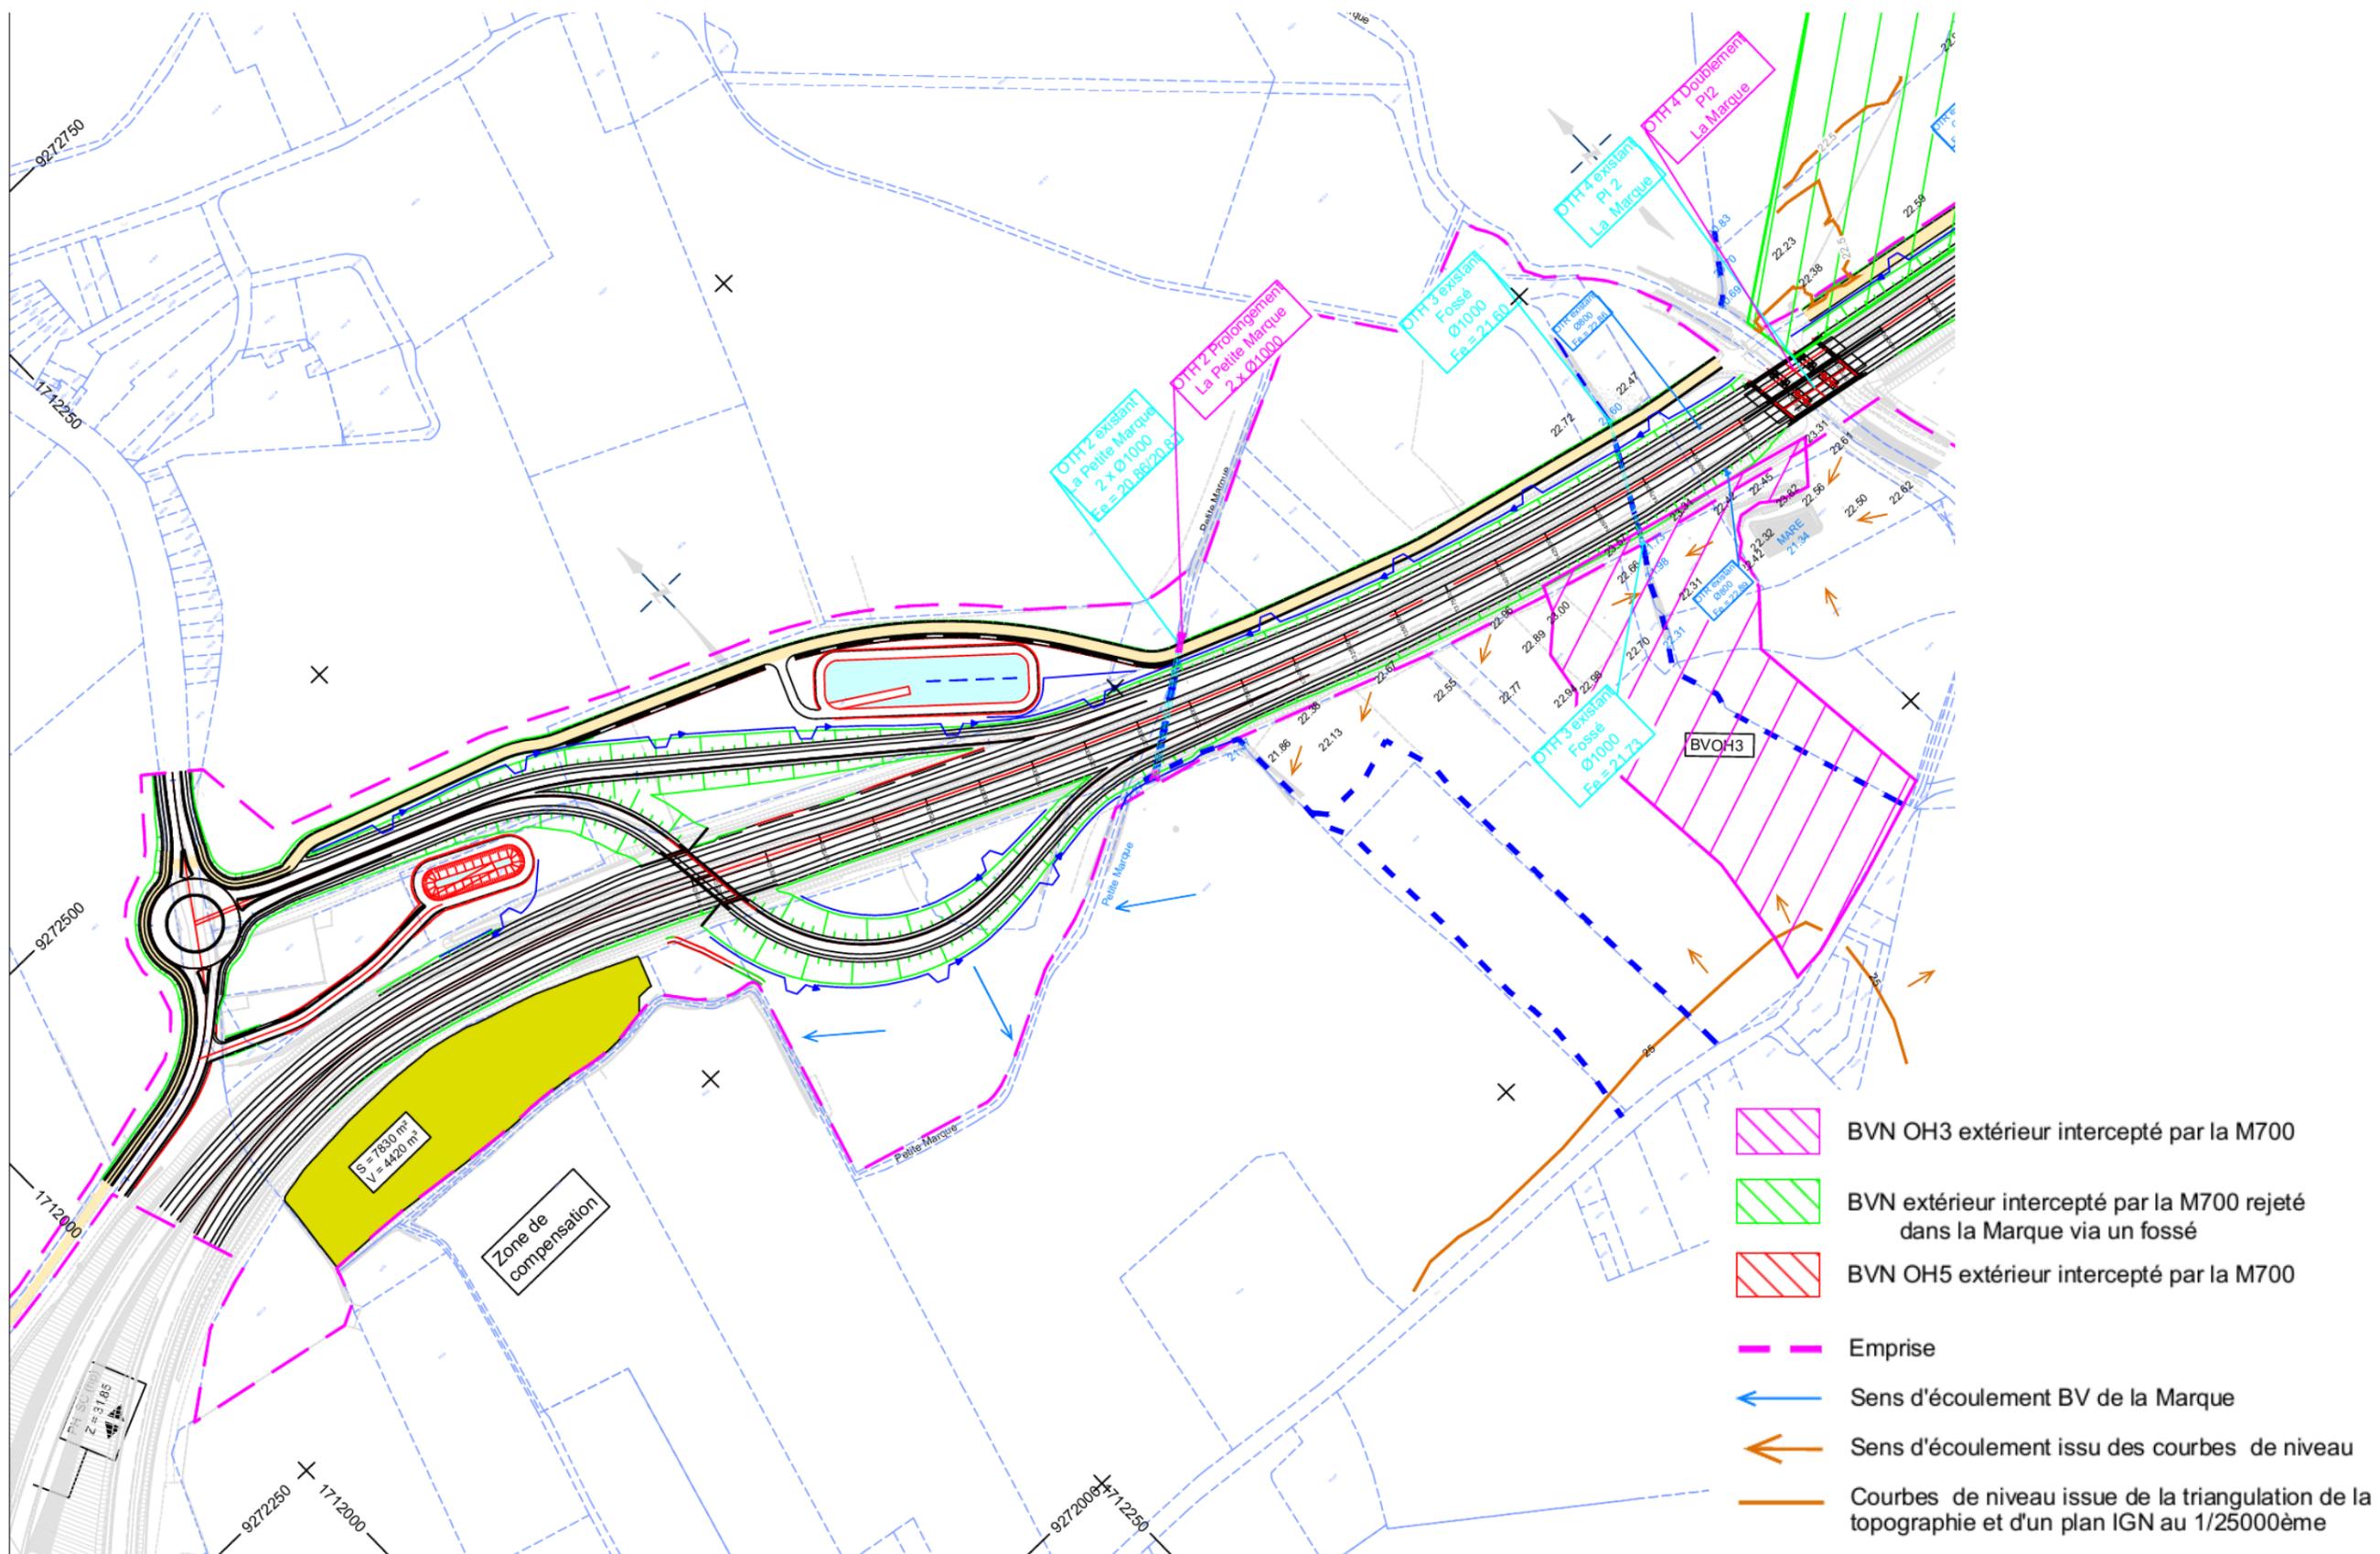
Bassins versant interceptés et ouvrages de transparence hydraulique sur plan parcellaire 1/2
